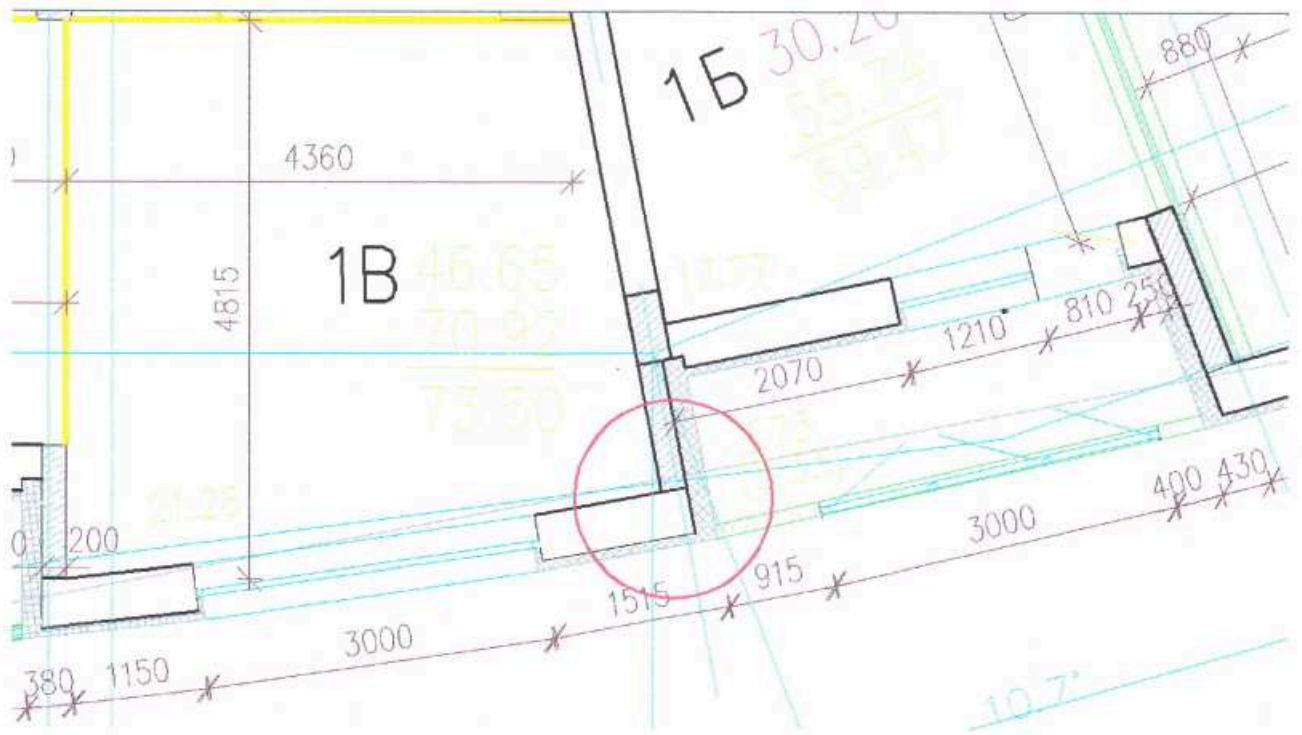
Фрагмент плана типового этажа жилого дома с расчетным узлом сопряжения наружных стен и диска перекрытия
